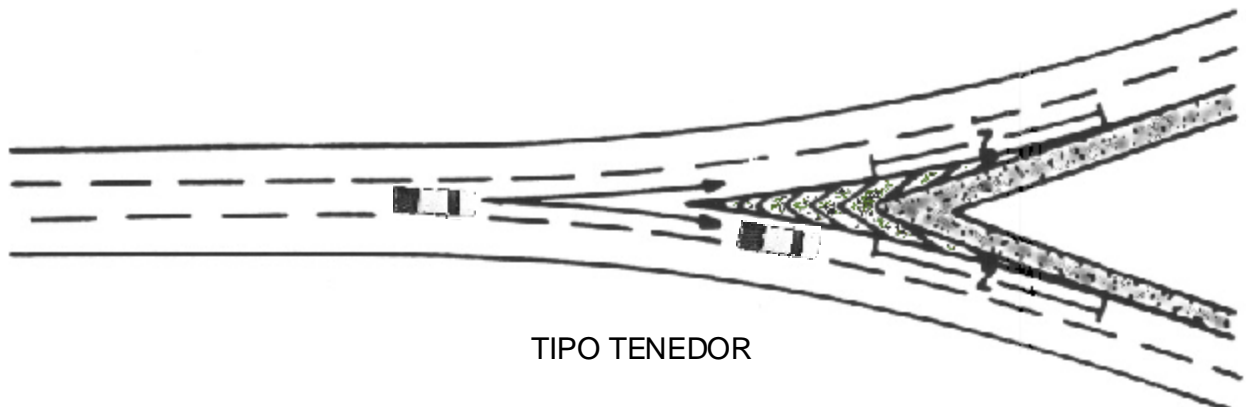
DETALLES TÍPICOS DE CUCHILLAS DE SALIDA
